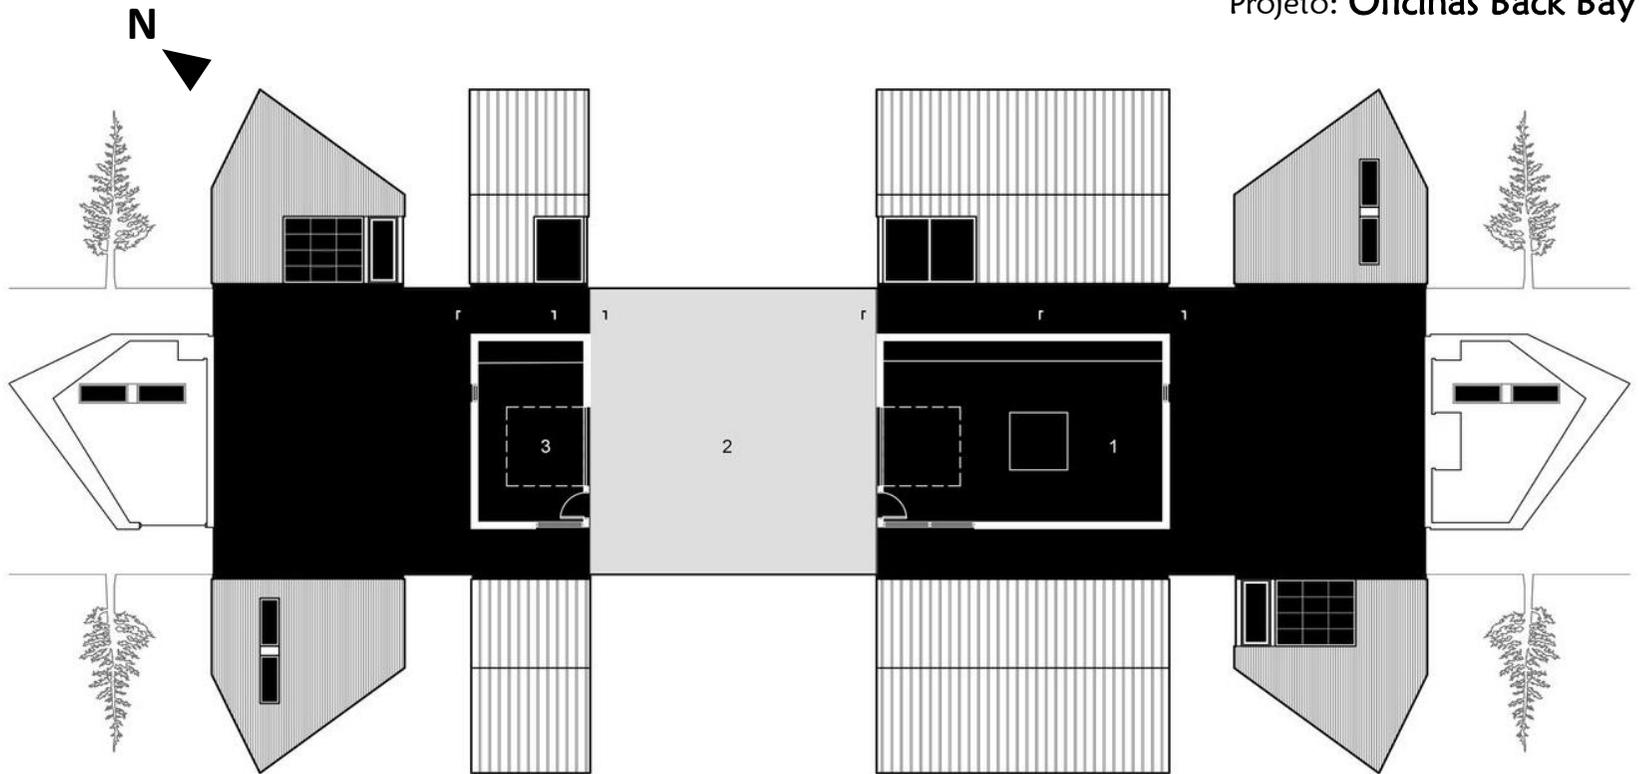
Esquema de planta baixa e fechamentos das Oficinas Back Bay
